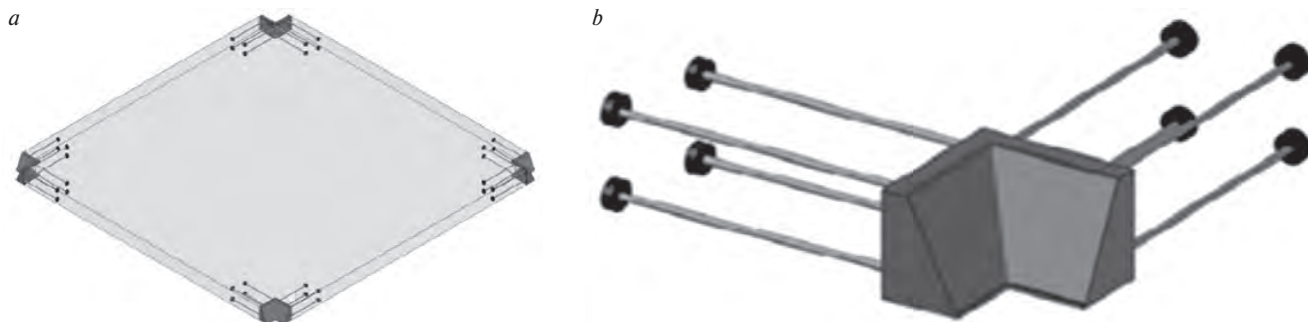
Плита перекрытия (a); закладная деталь (b)
